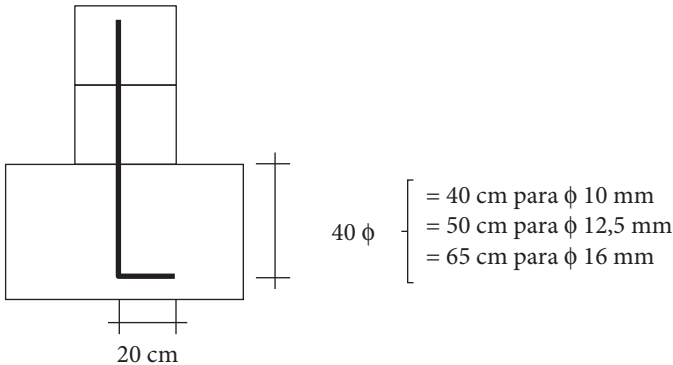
Esperas de armaduras verticais em estrutura de apoio.
